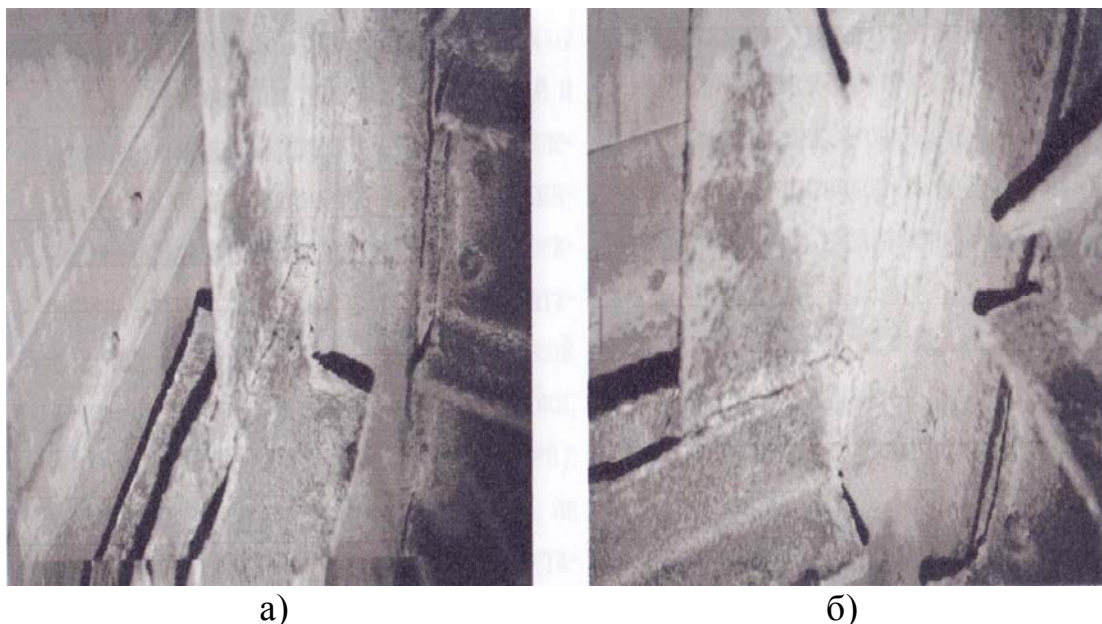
Коррозионные повреждения узлов ферм станка шахтного копра при потерях сечений более 40%: а) деформации элементов и разрушение сварного шва; б) трещины в сварных швах.
